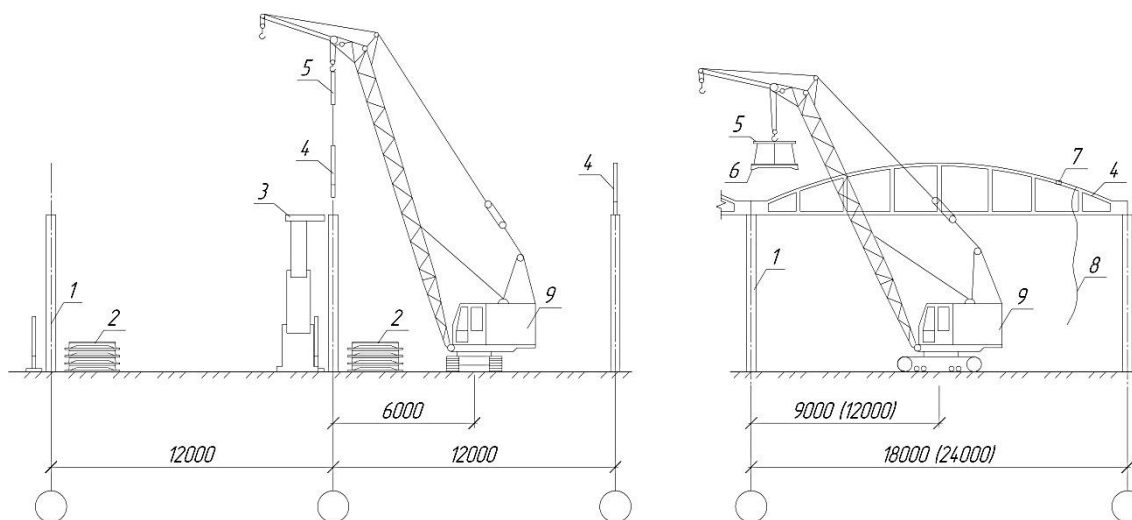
Схема монтажа ферм пролетом 18, 24 м и плит покрытия поперечным методом: 1 – колонна; 2 – штабель плит; 3 – телескопическая вышка; 4 – стропильная ферма; 5 – траверса; 6 – плита покрытия; 7 – инвентарная распорка для временного крепления ферм; 8 – оттяжка из пенькового каната; 9 – кран
